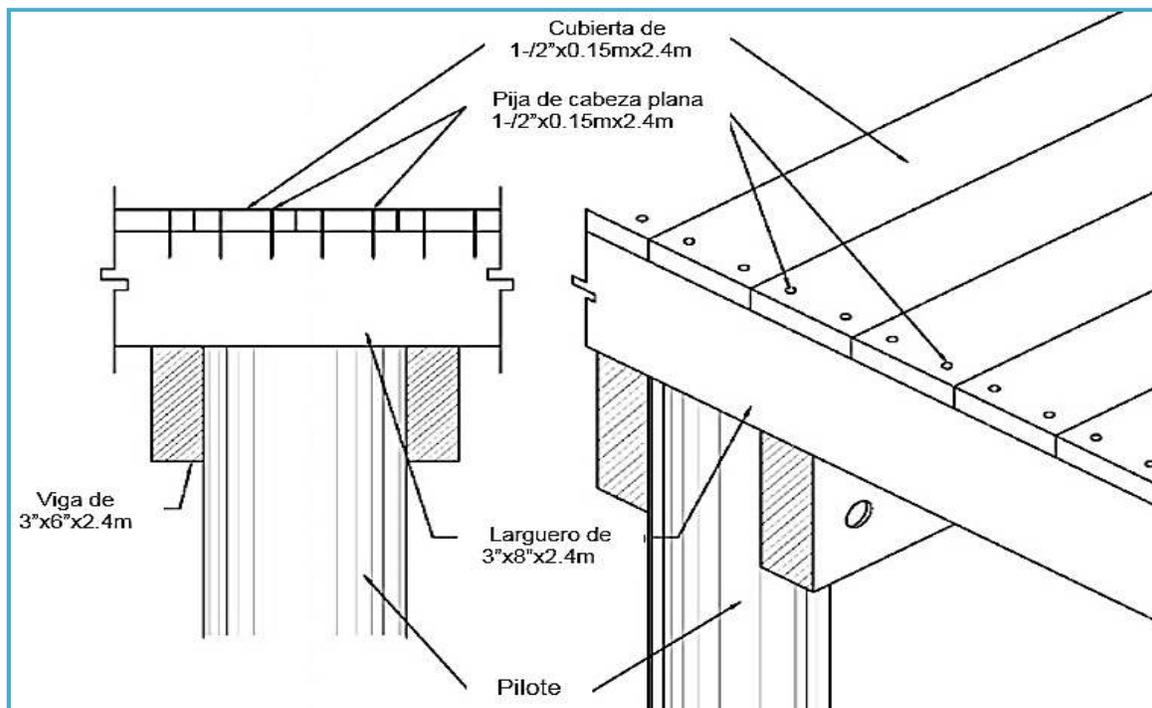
Detalle de la cubierta de madera del muelle.
